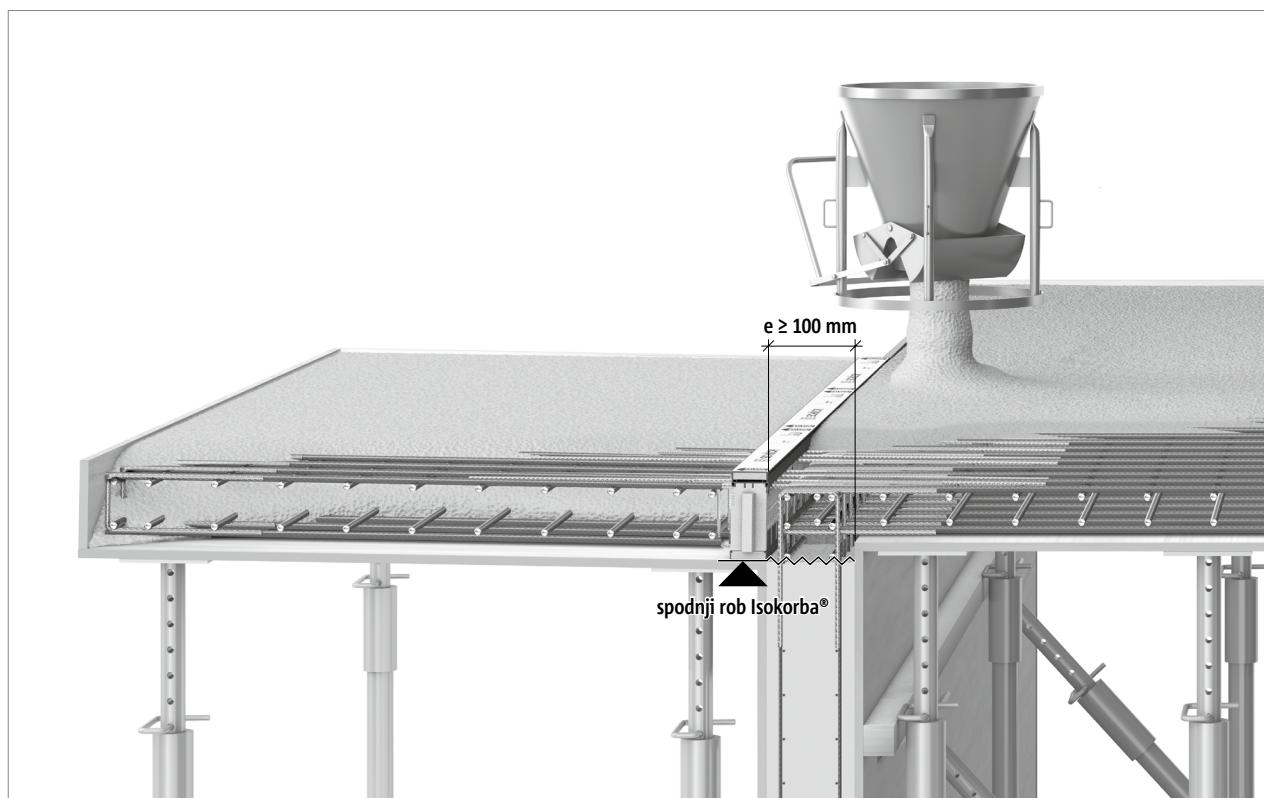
Schöck Isokorb® T tip KL: priprava armature za betoniranje in nameščanje T tip KL
